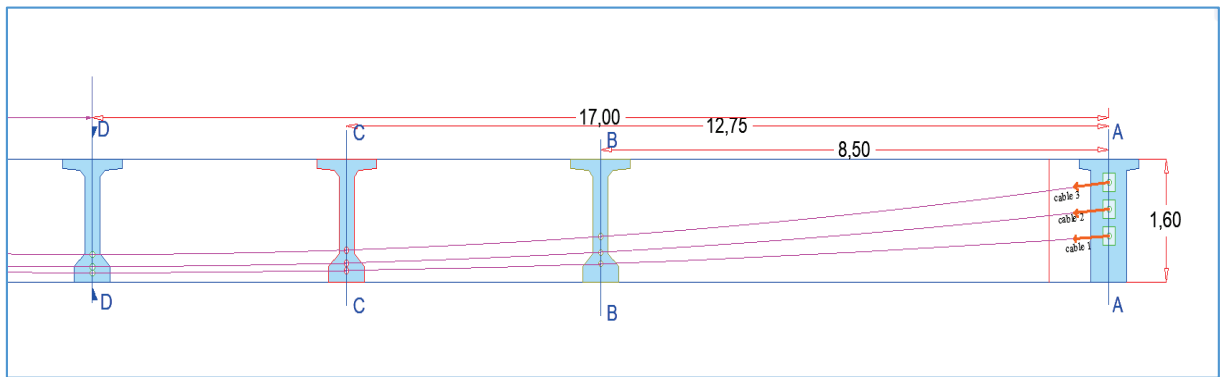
Tracé de la précontrainte - coupe longitudinale-
